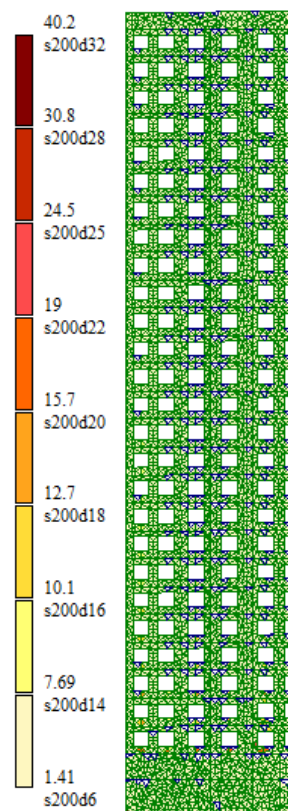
Схема армирования стен по оси Y (у верхней грани)
